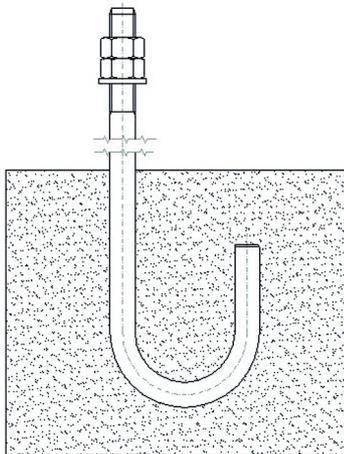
Fondations pour la fixation du groupe pompe moteur.
